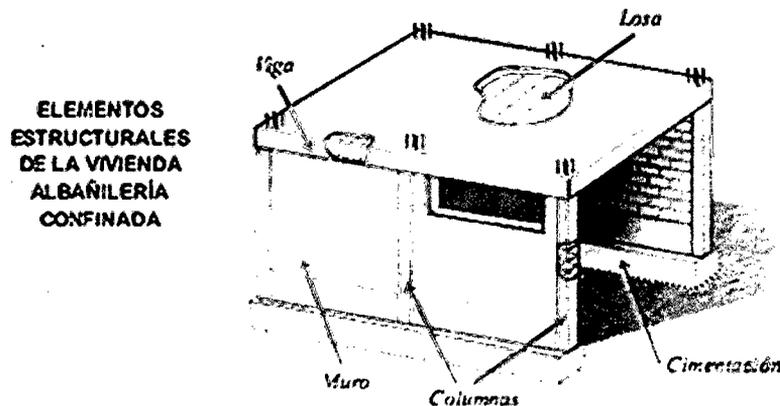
Albañilería Confinada (imagen www.acerosarequipa.com)
